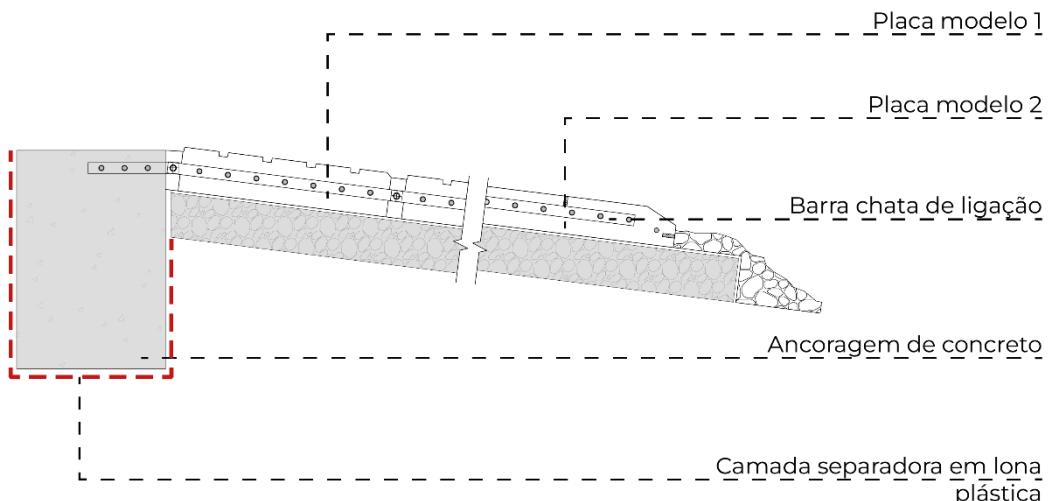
Trecho executado com placas pré-moldadas (Trecho 03)
